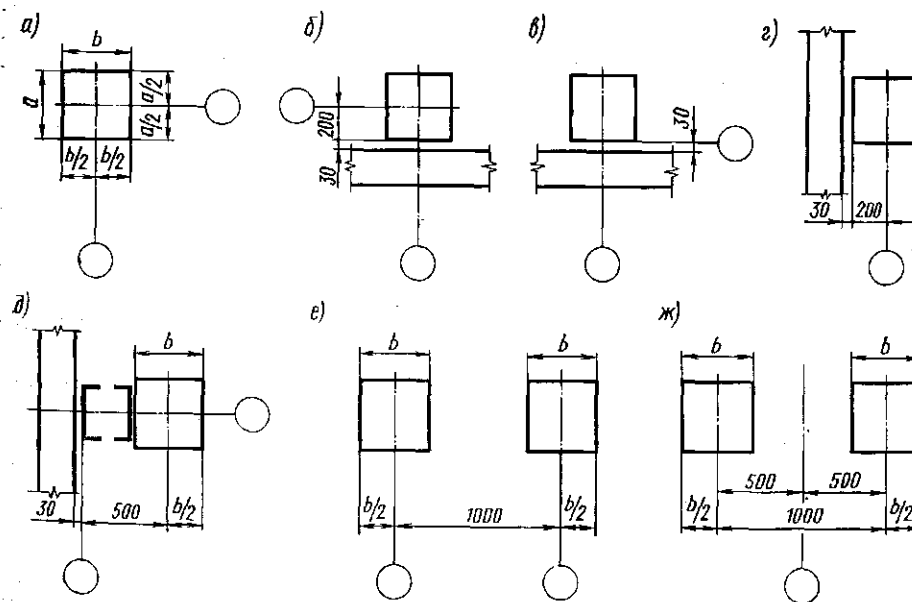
Привязка колонн и стен многоэтажных зданий к разбивочным осям: а — привязка колонн к средним осям; б, в — привязка колонн и стен к крайним продольным осям; г, д — то же, в торцах зданий; е, ж — привязка колонн по линиям поперечных температурных швов
